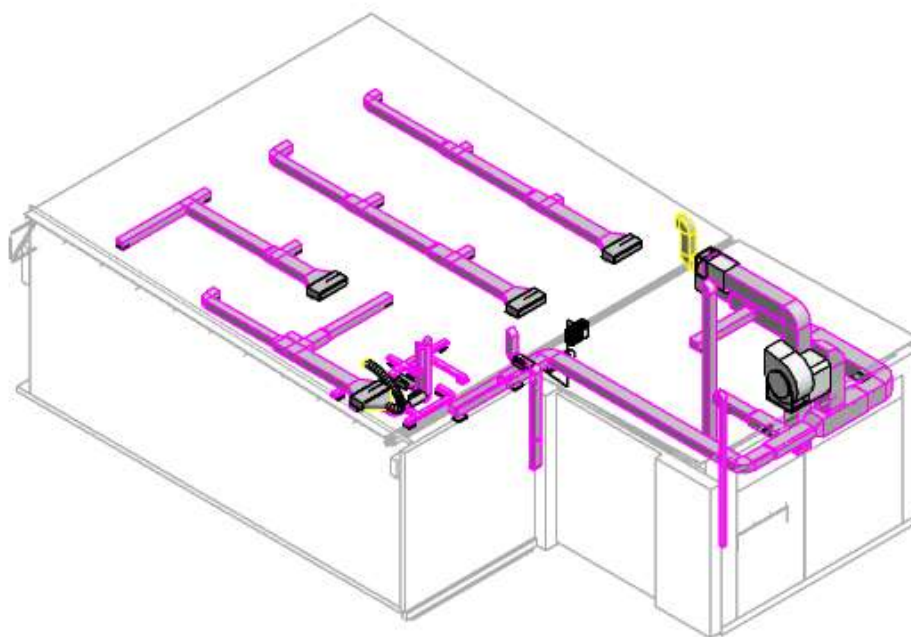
36 :Vista isométrica de HVAC en planos para construcción.
